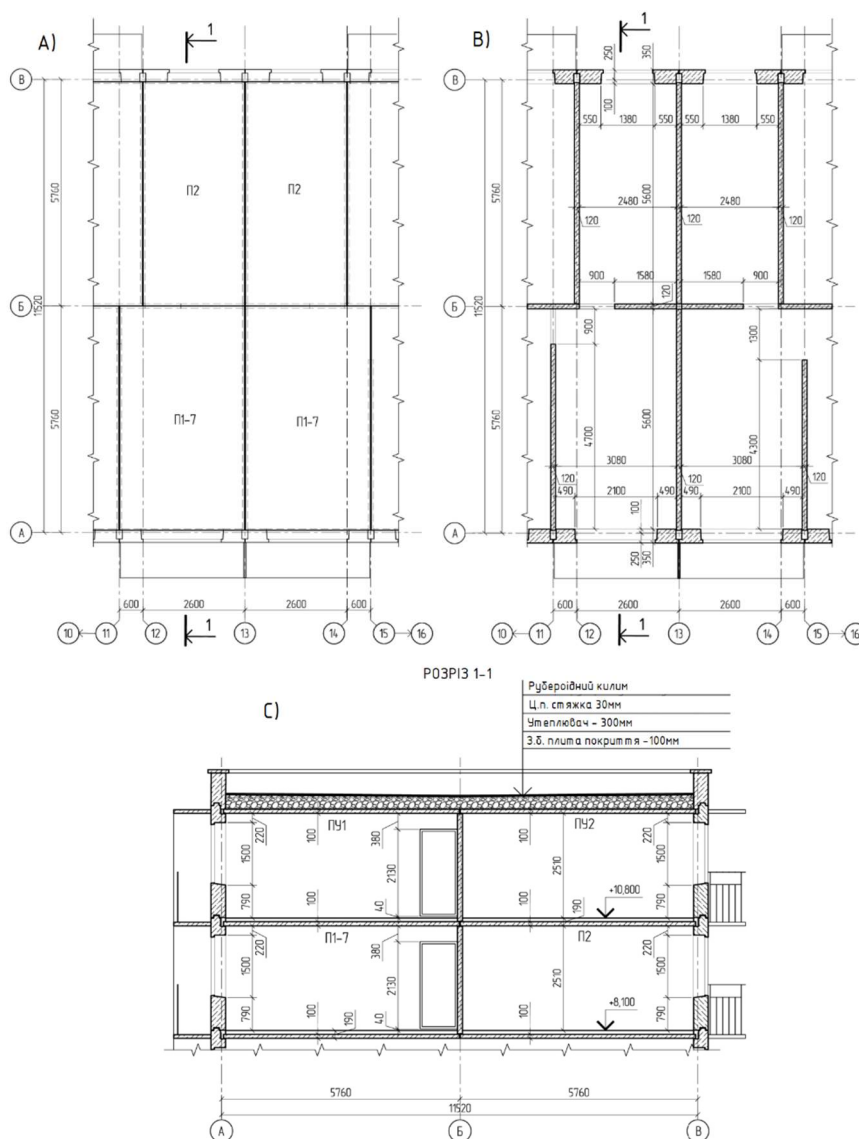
Фрагмент типового планувального рішення великопанельного житлового будинку:
